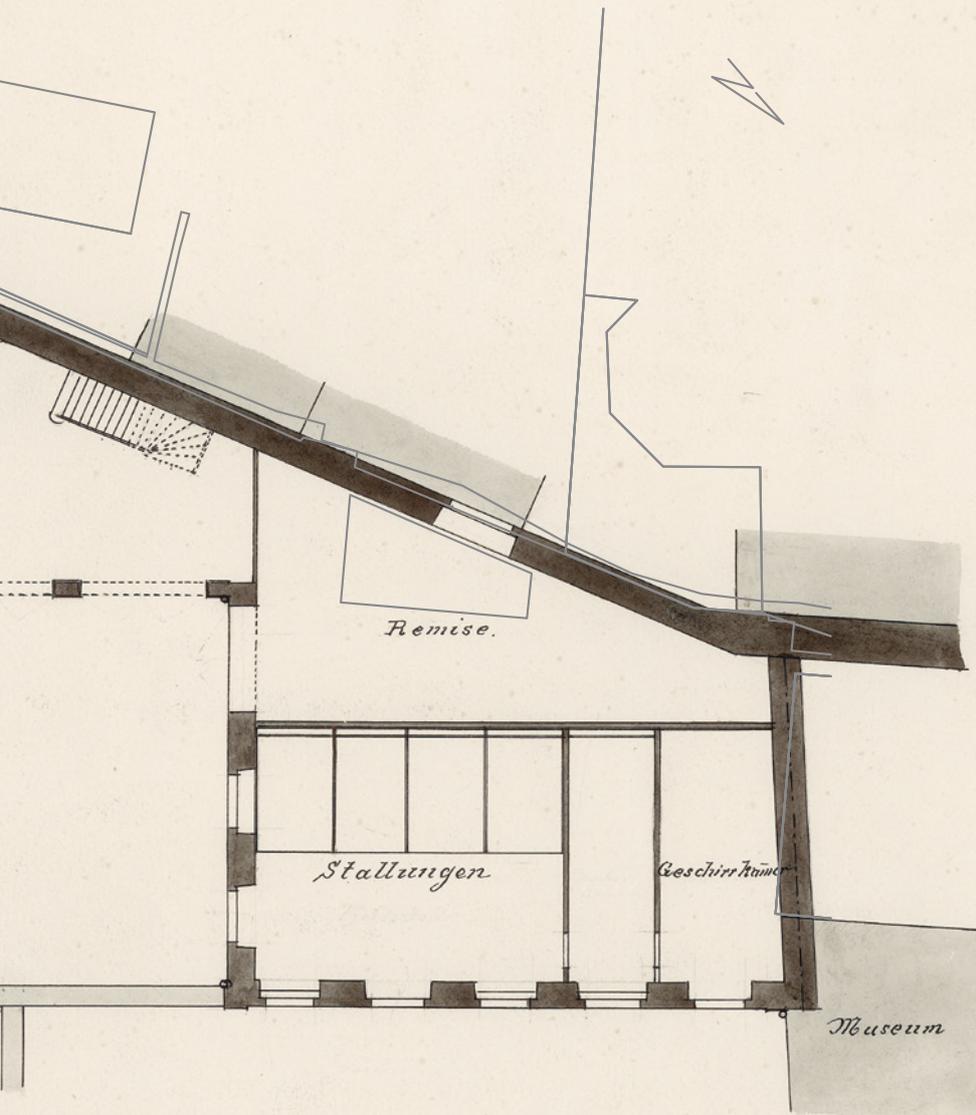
Plan des Fabrikgebäude-Erdgeschosses mit Bezeichnung der Räume, aufgenommen vor 1913, hier verkleinert abgebildet. StABS, Planarchiv E 1, 67. Bearbeitung: Udo Schön.
